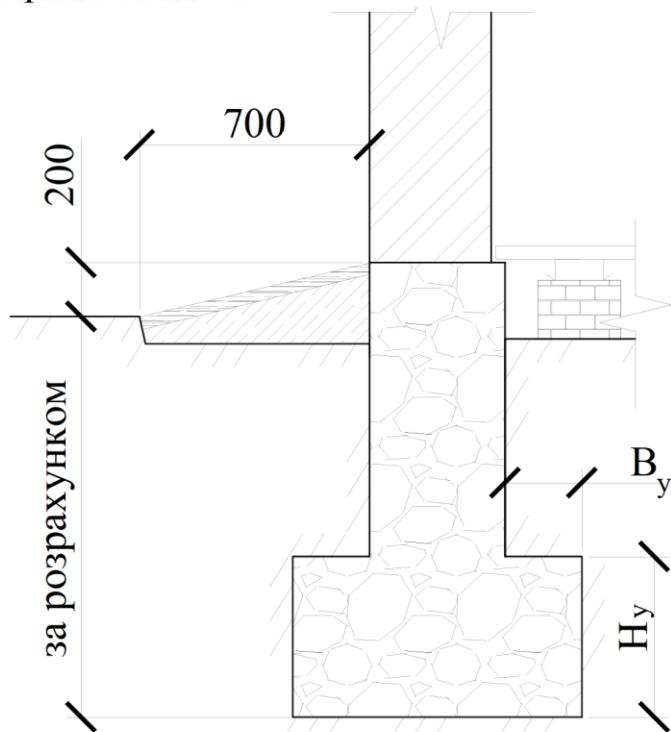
Стрічковий бутовий фундамент з уступами
